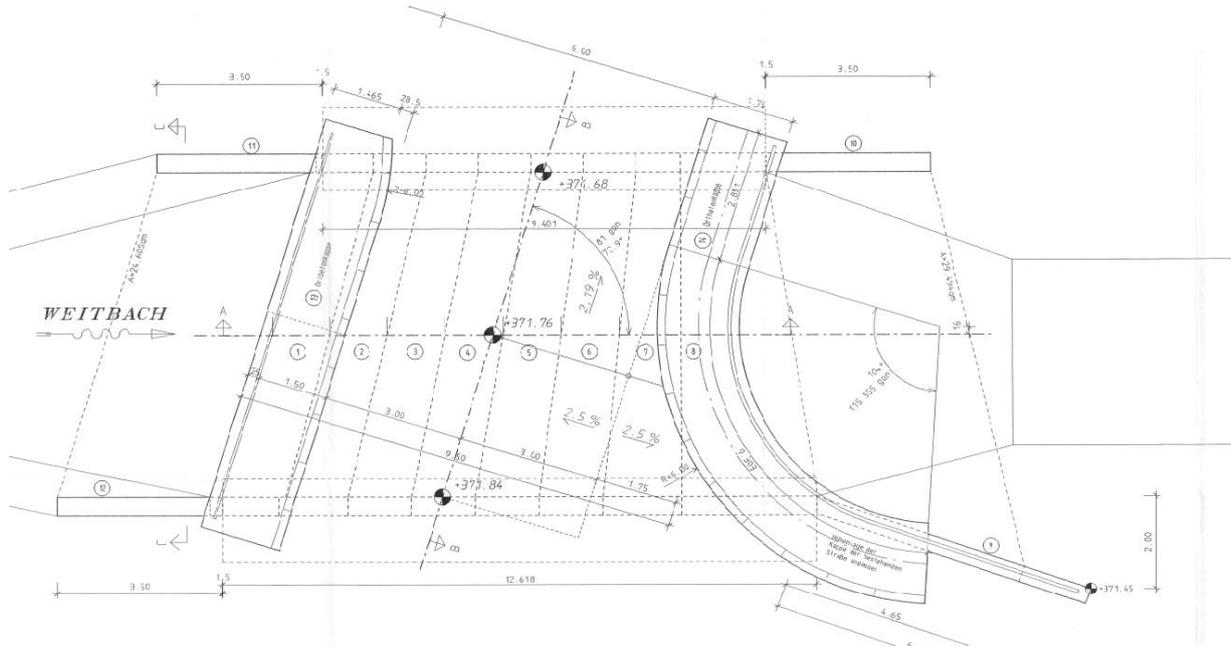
Lageplan Bestandsbrücke Hauptstraße (LRA Altötting)
